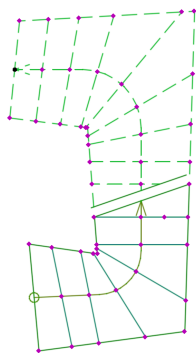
· Grundriss: genormte Darstellung mit Bruchlinie und Lauflinie.
